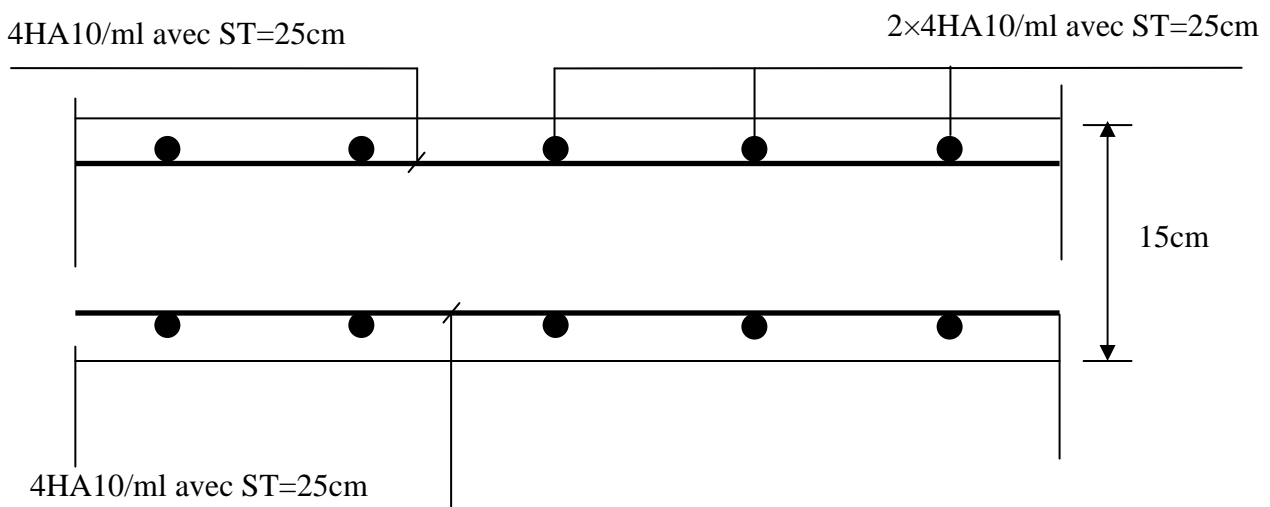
Ferrailage de la dalle dans le sens x-x.
